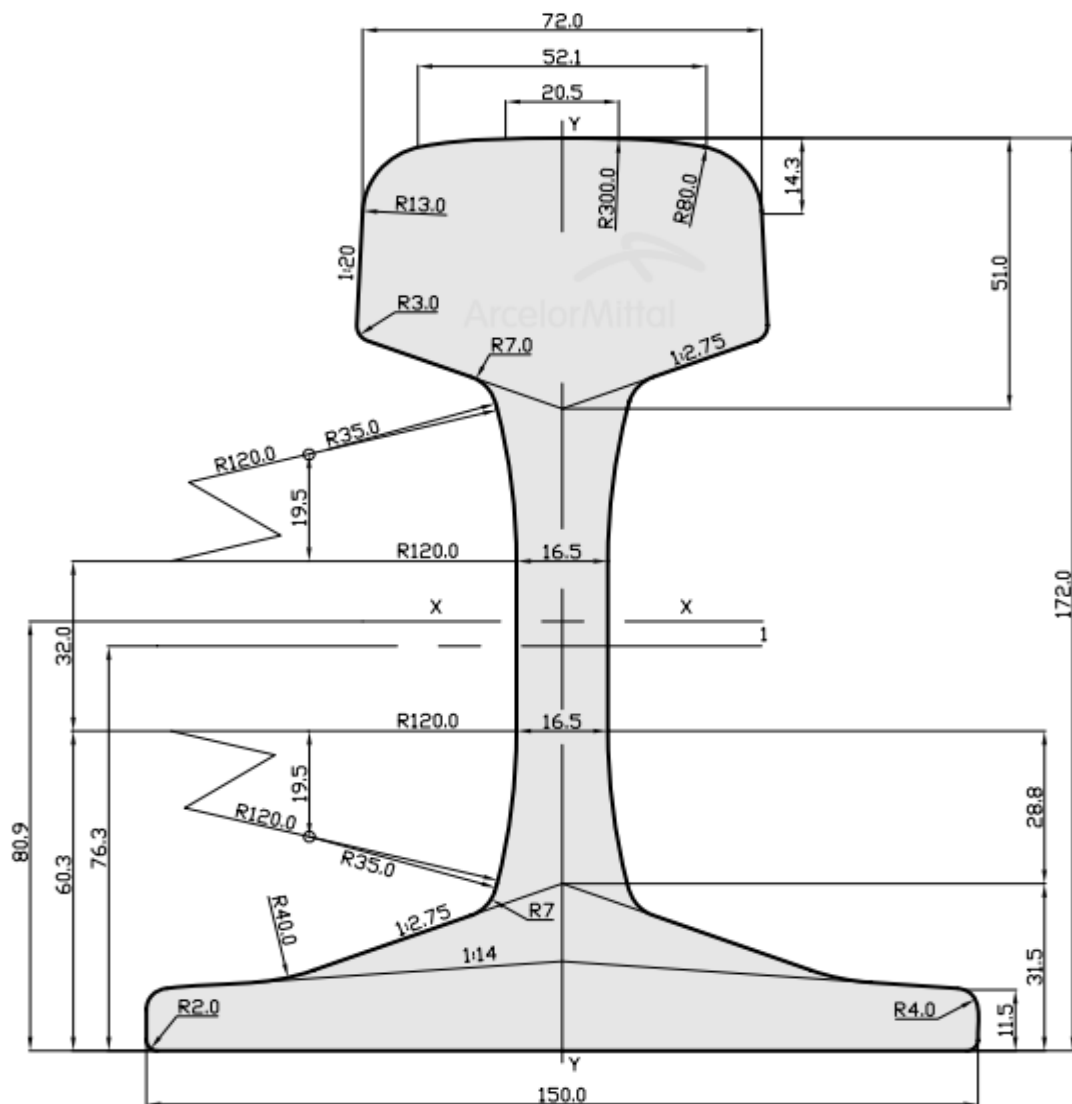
Rail Vignole de type UIC 60E1.
